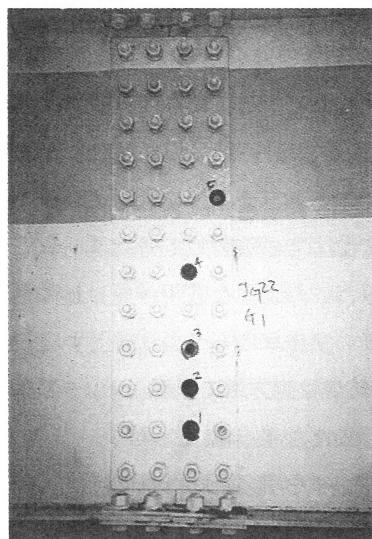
高力ボルト継手部における高力ボルトの遅れ破壊事例
